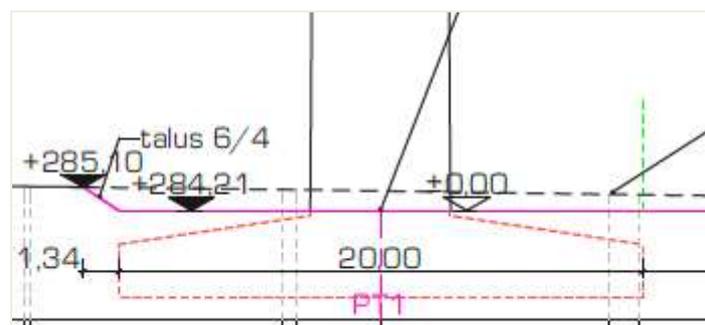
Profil de la fondation de l'éolienne 1 (source : demande de permis, Gbo, 2020)
